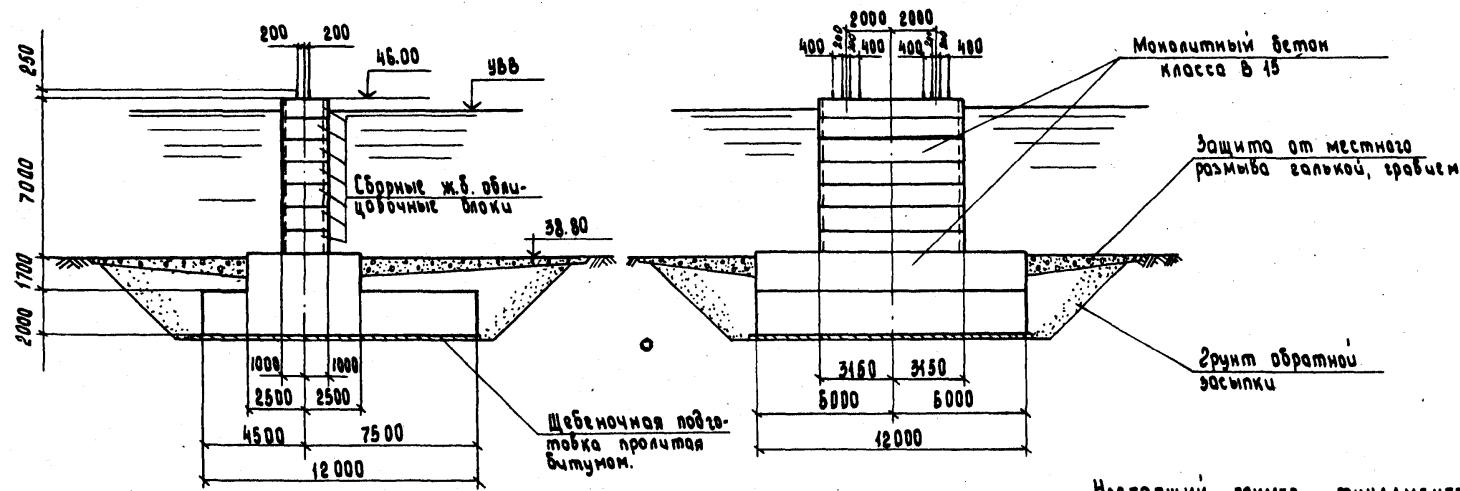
Спаренные фундаменты под две ноги опоры. Вариант фундамента со сборными плитами в основании
